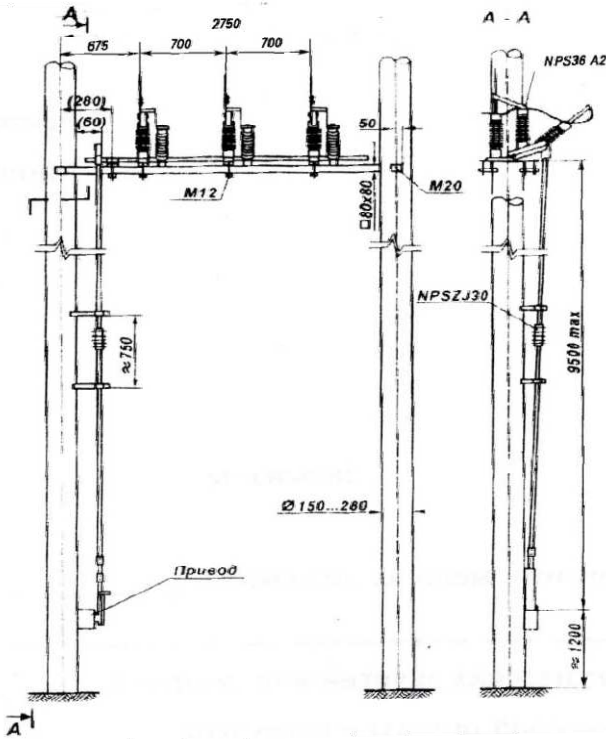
Разъединитель типа NPS-35 кВ для ВЛ и МТП
